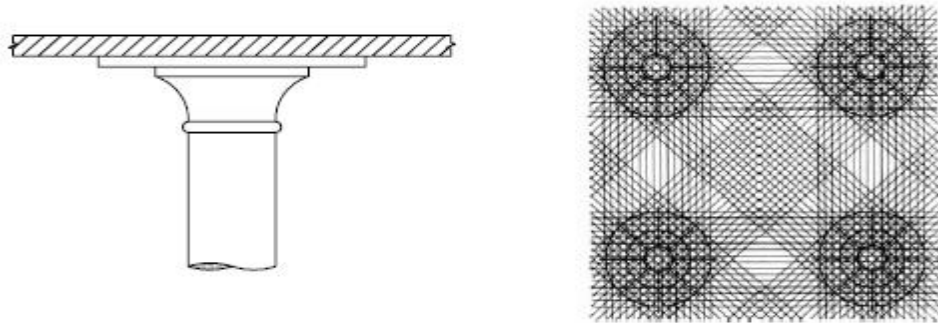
Plancher-dalle avec chapiteau ; barres d'armature disposées dans quatre Directions, 1905, C.A.P. Turner [36]
